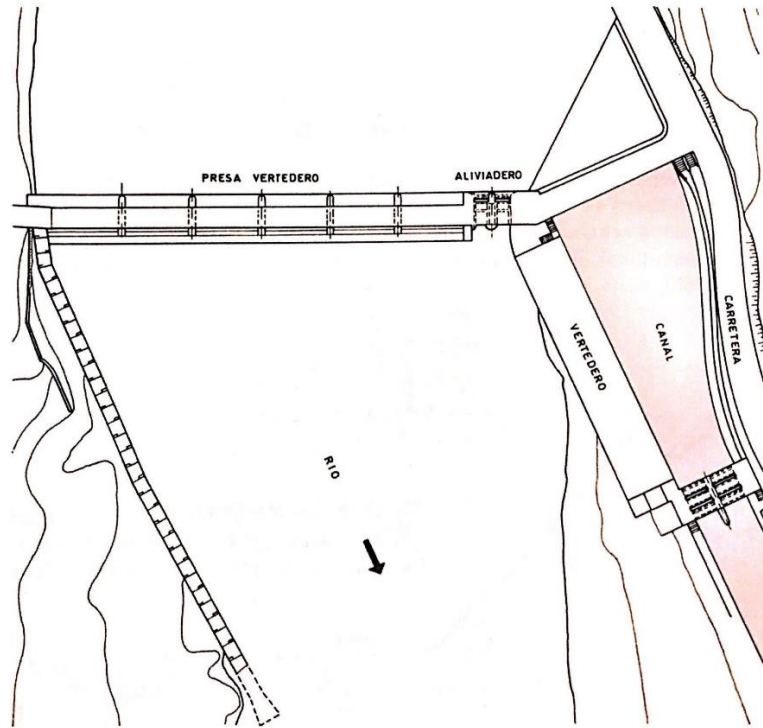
Representación en planta de presa con vertedero en canal. [19]
